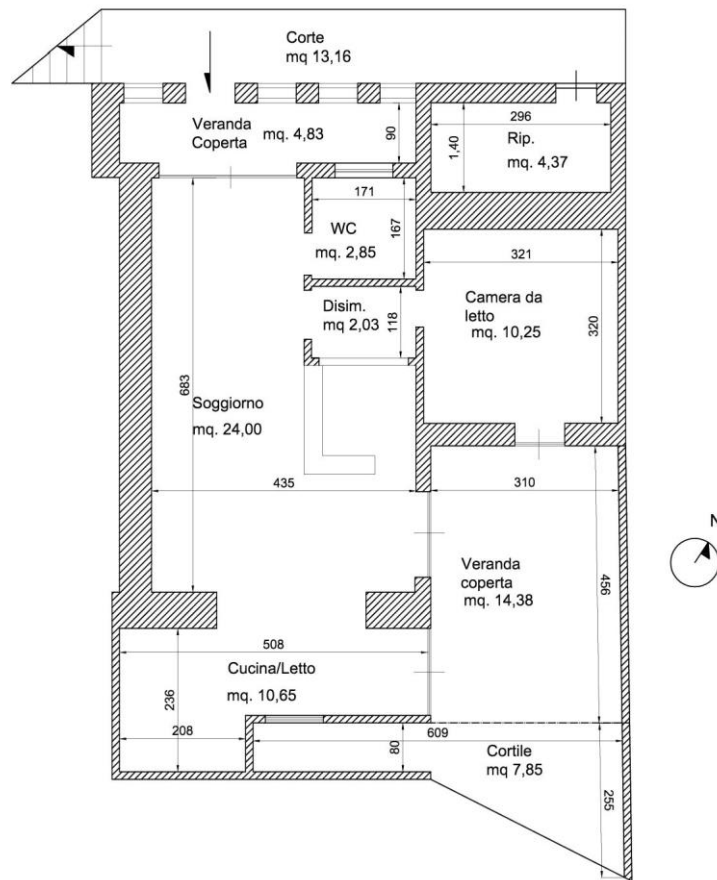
Planimetria immobile sito in Via Lungomare delle Anticaglie n.20 - Rilievo dello Stato dei Luoghi
